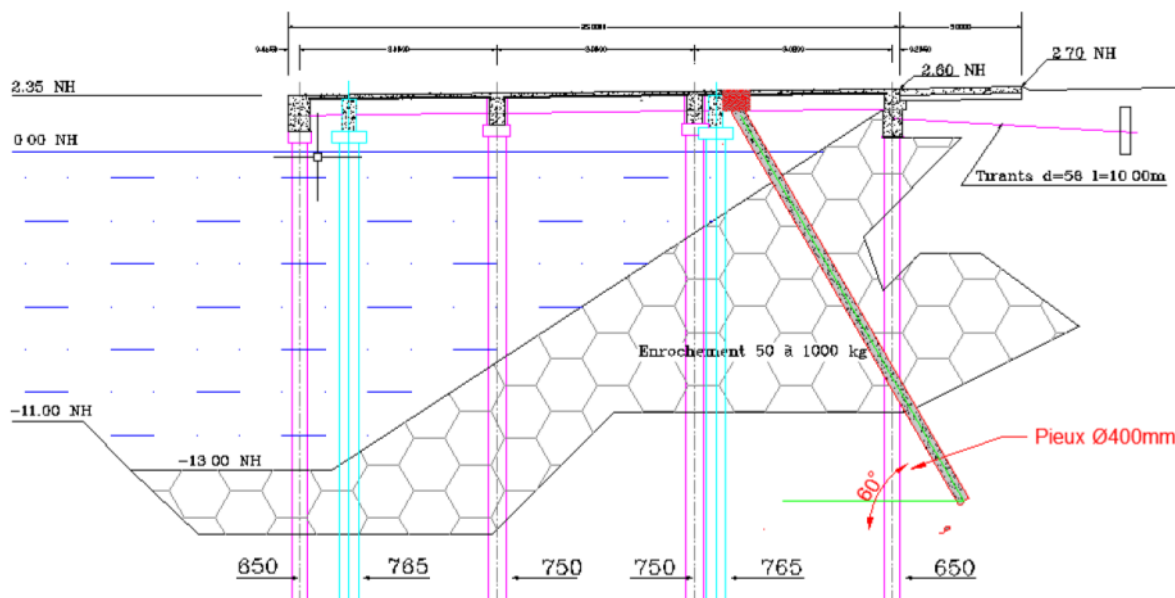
Coupe type - Principe de renforcement avec pieux inclinés (source : SUEZ Consulting)
